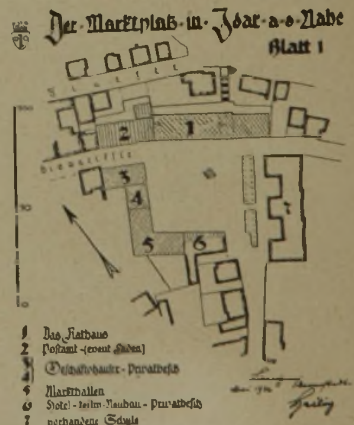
(links). Erdgeschoß-Grundrisse. (1 : 1500.)
